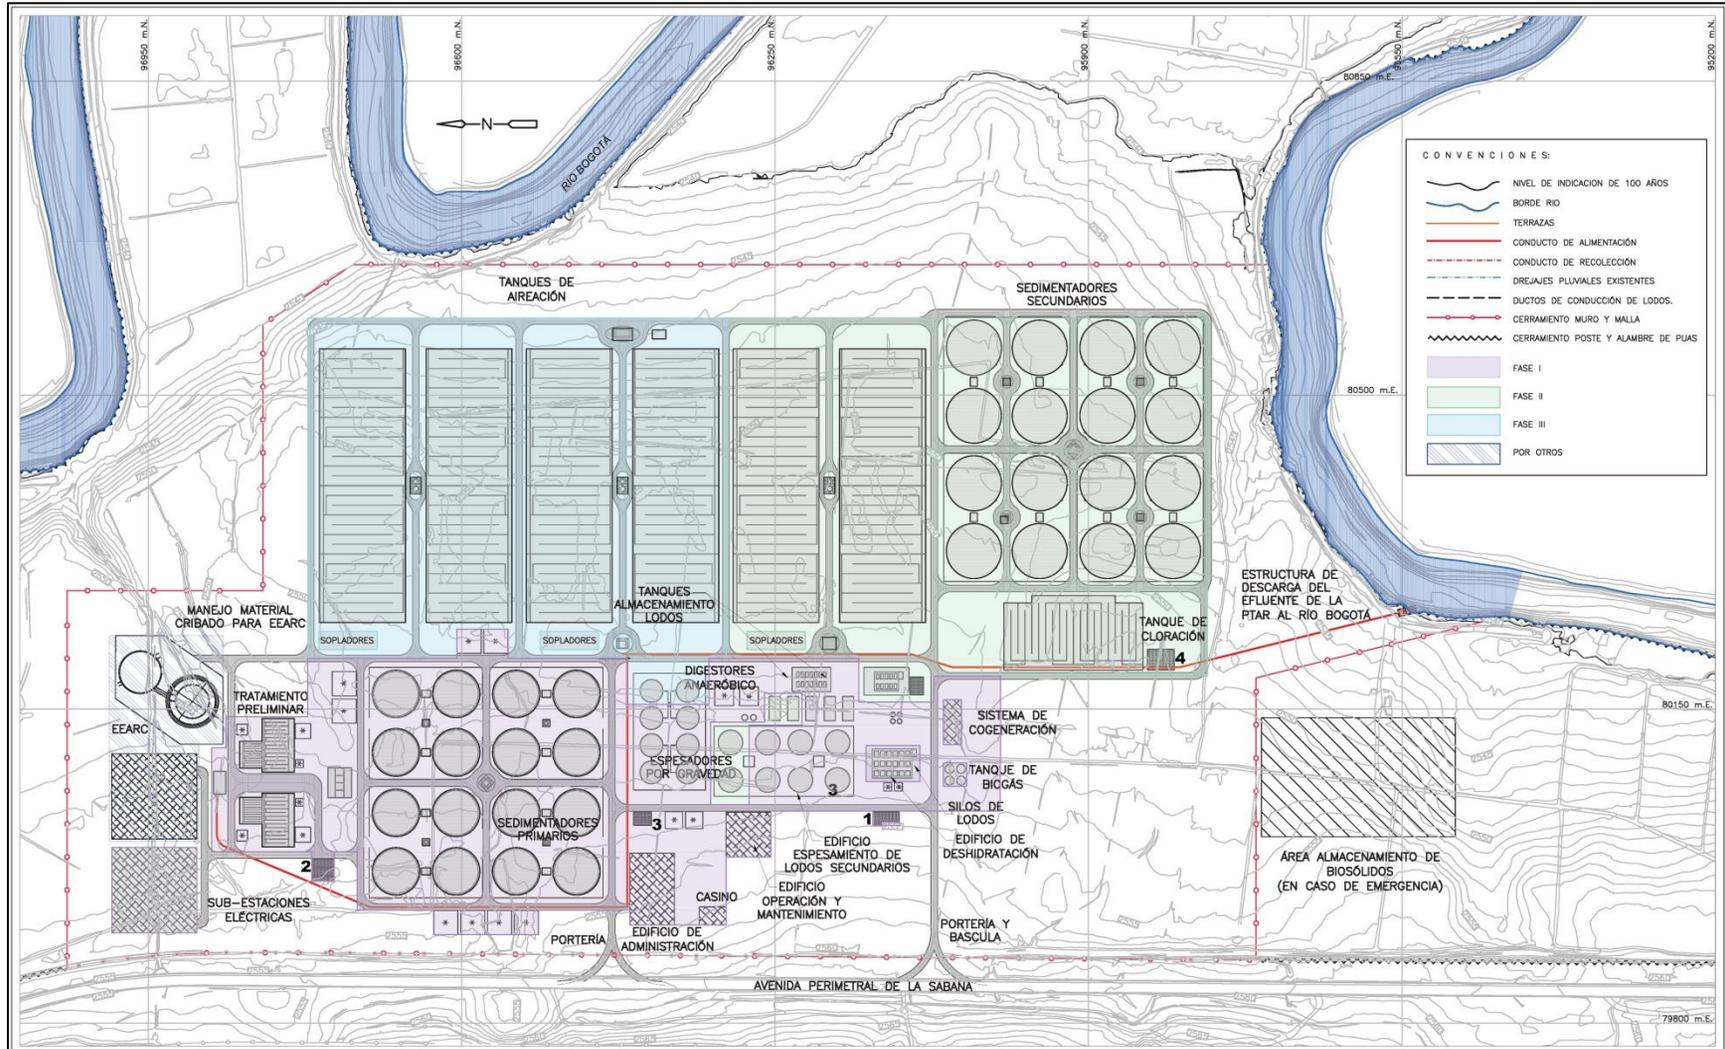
Alternativa 1 de layout en el terreno de Canoas
